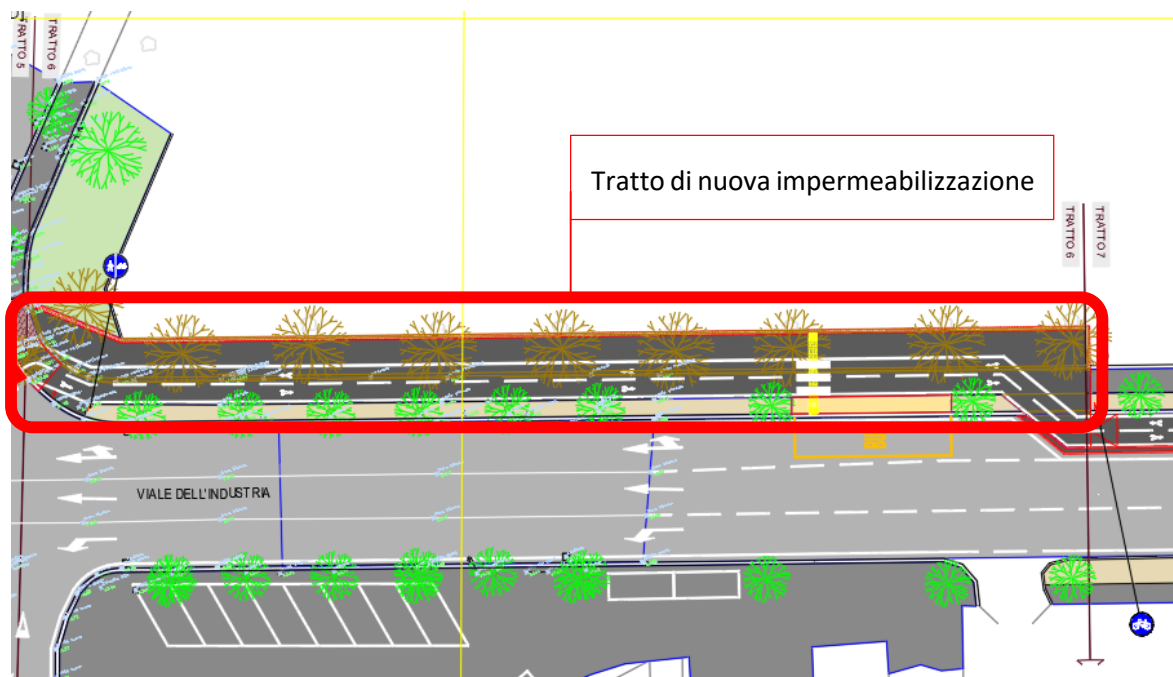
Dettaglio planimetrico intervento via dell'Industria (tratto 6)
